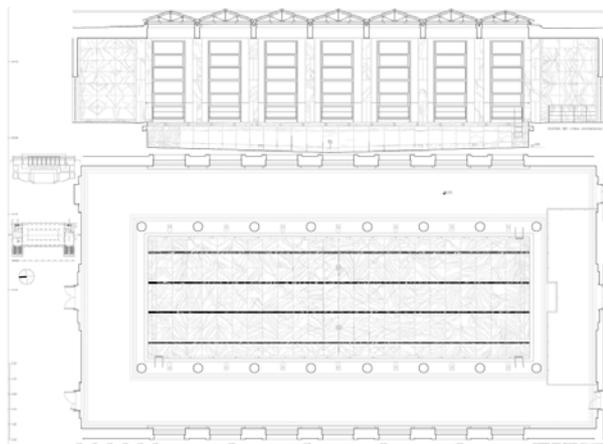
Levantamento arquitetônico da Piscina Pênsil, planta e perfil longitudinal.
